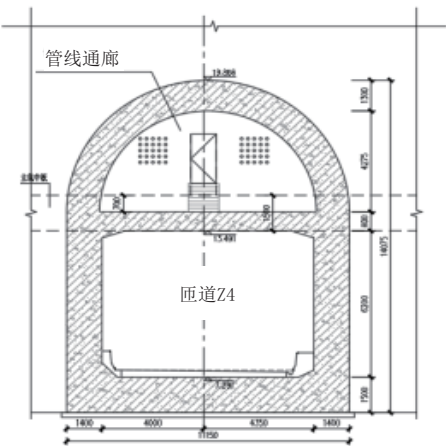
主线南侧匝道 Z4 横断面图(单位:mm)
